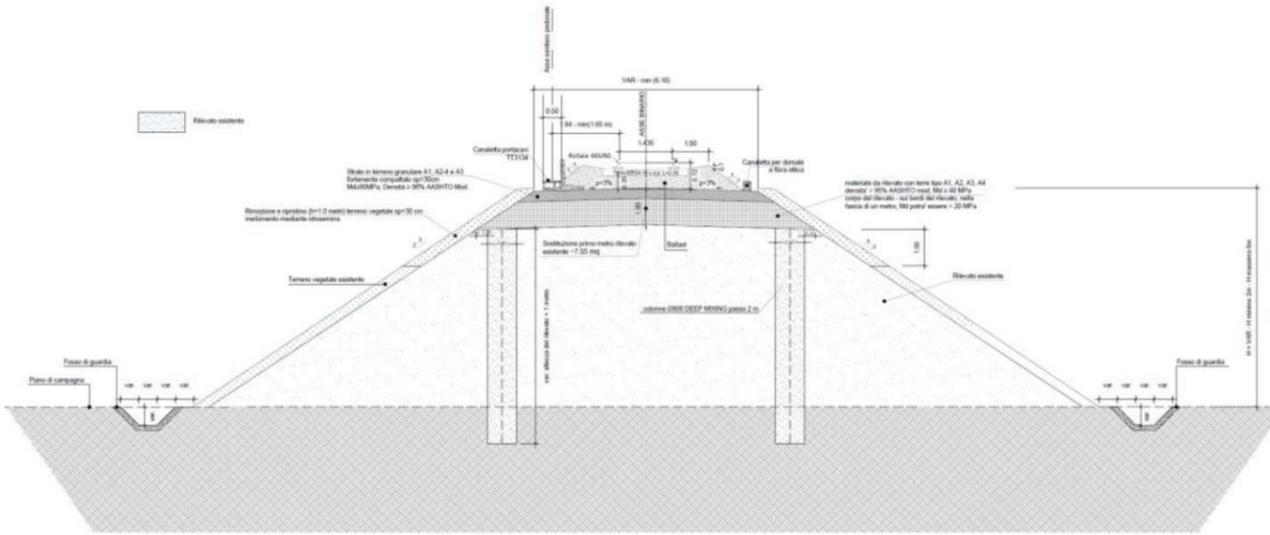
Sezione tipo 2 per rilevati di altezza da 2.00m a 6.00m.
